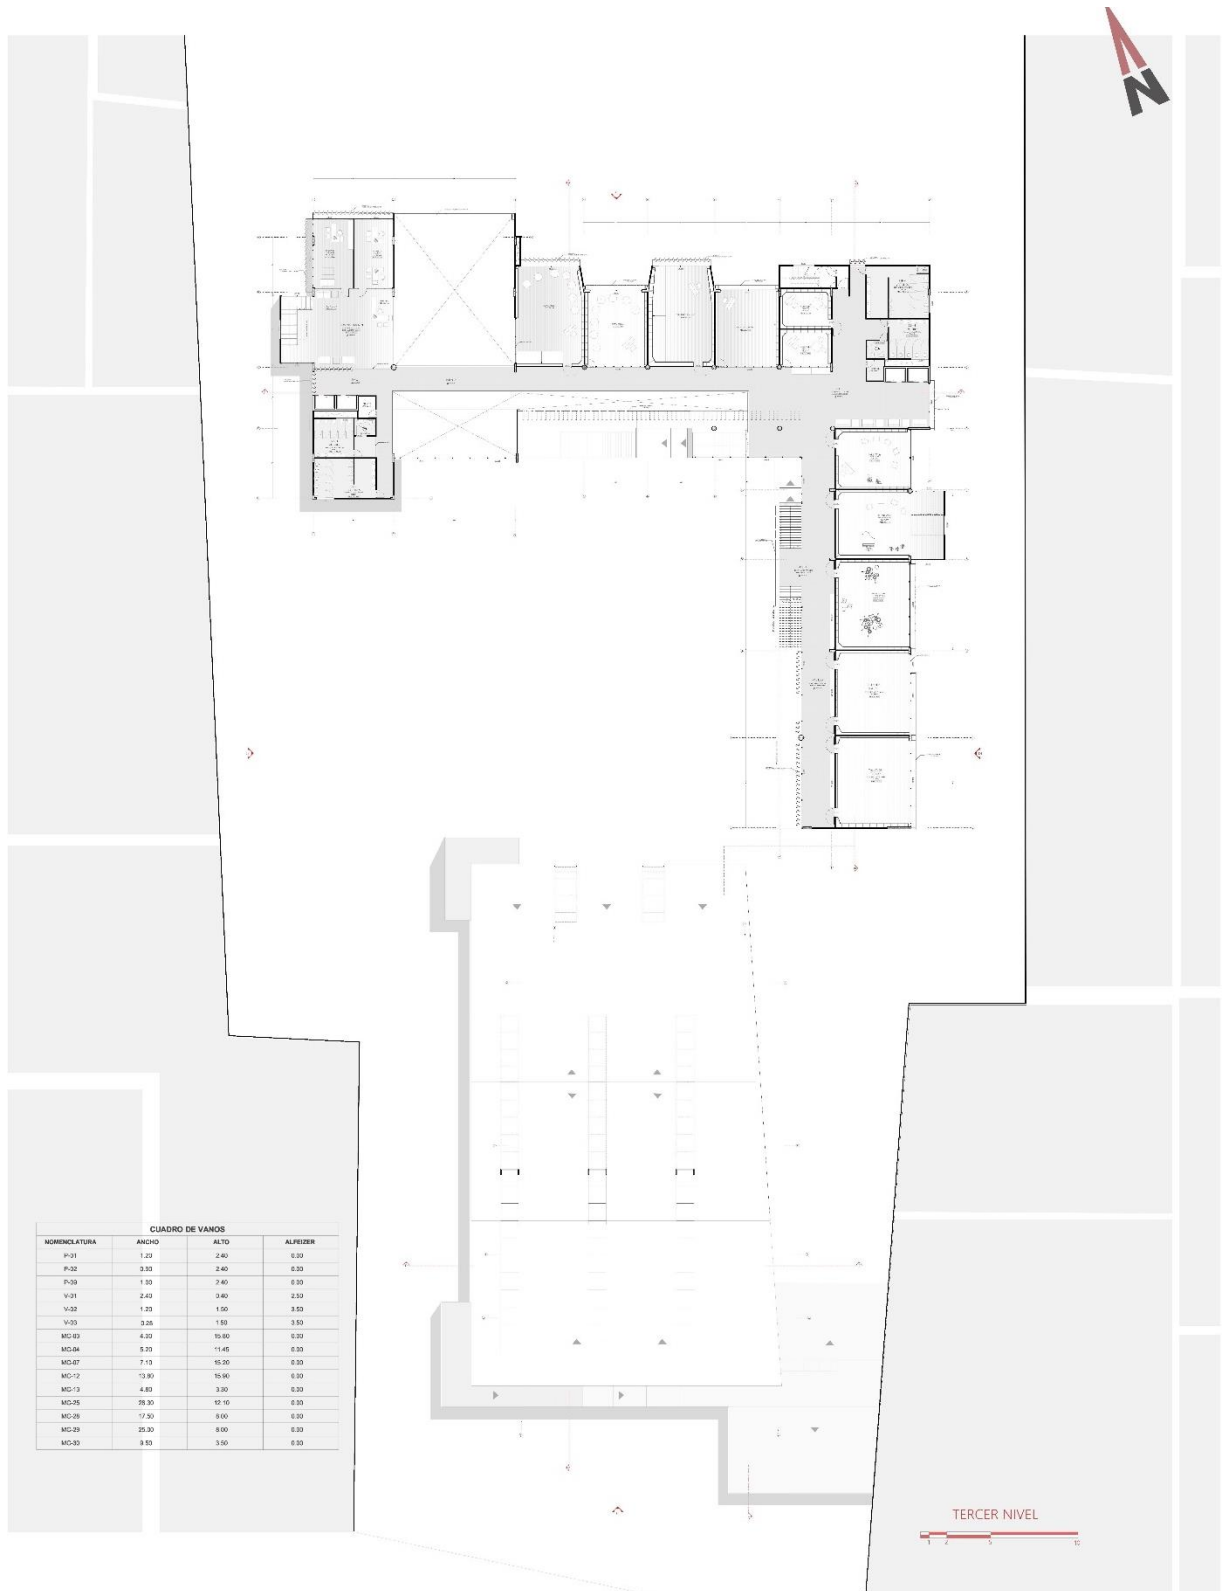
Zonificación de espacios – Planta Tercer nivel
